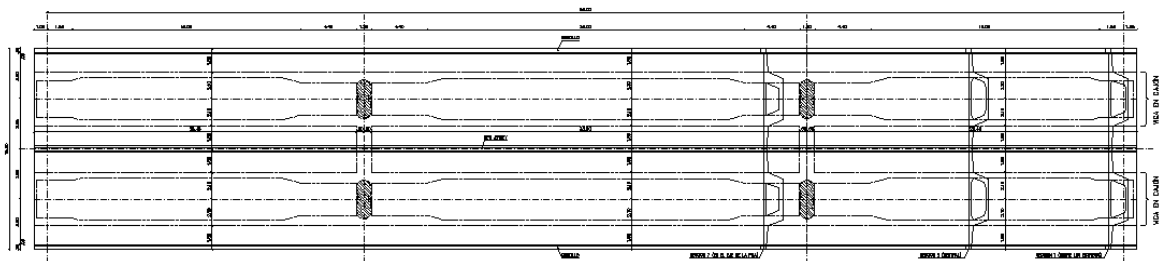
Vista en planta, puente de referencia. Fuente: INTERDICO LTDA
